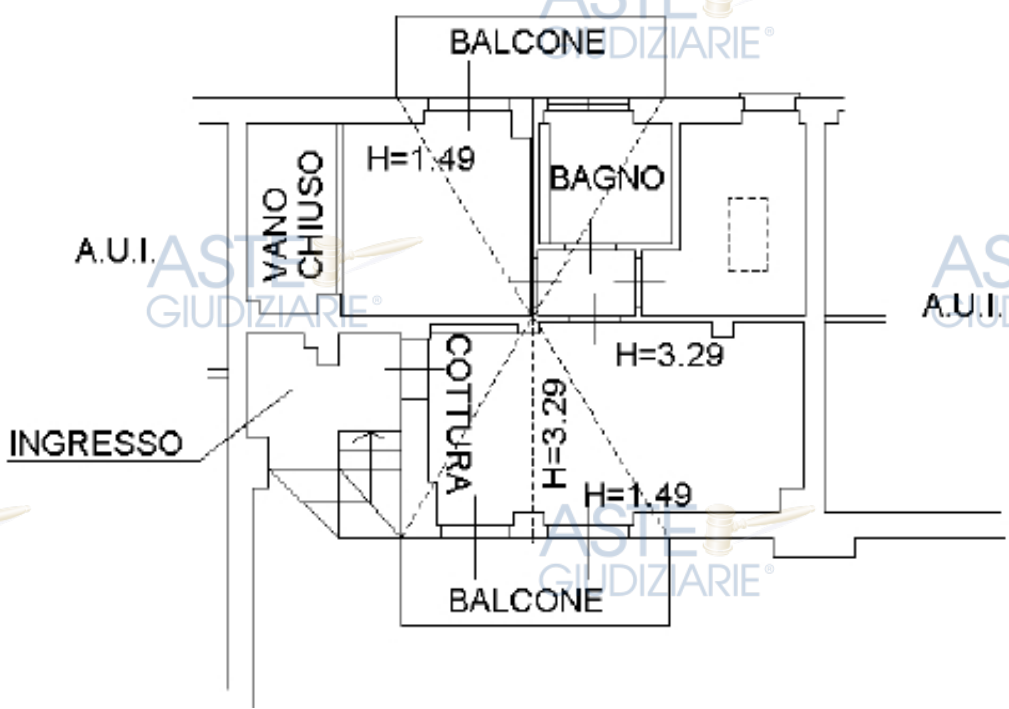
Part. 336 sub. 53 abitazione piano secondo
